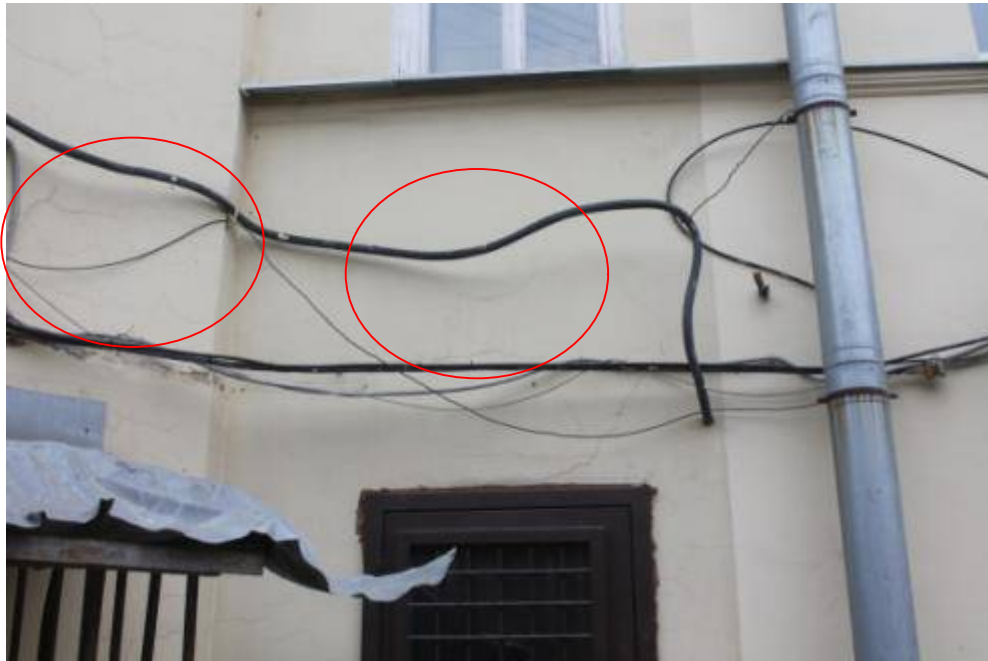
Система волосяных трещин в штукатурном слое, фасад по оси «Б».
